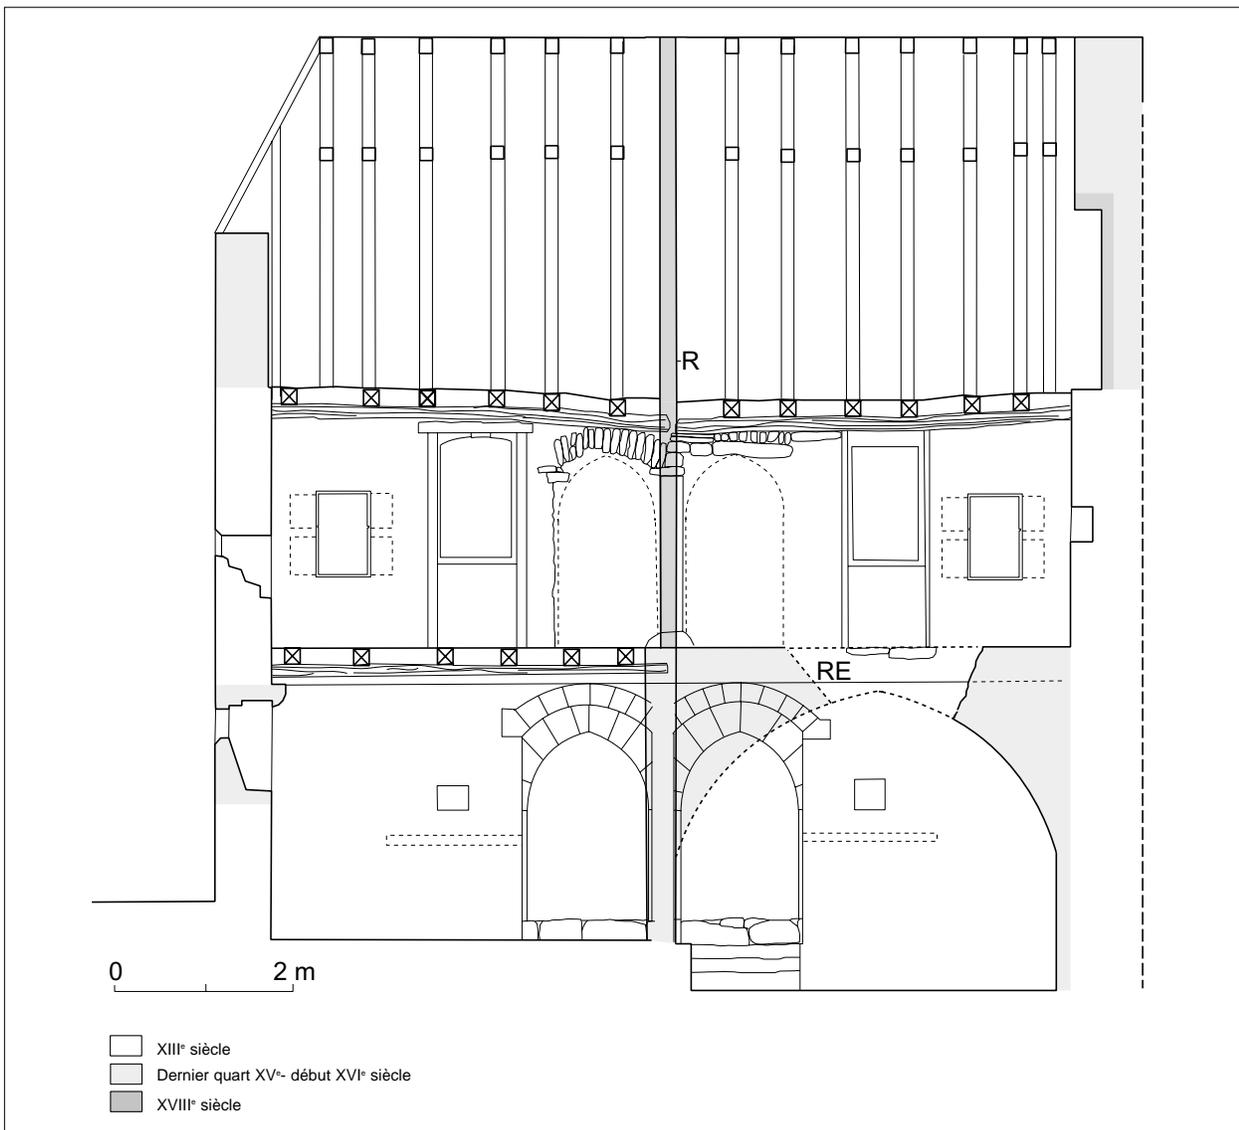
MAISONS JUMELLES N° 1. Coupe longitudinale AA sur le revers de la façade ouest. *Relevé V. Rousset, 2001.
